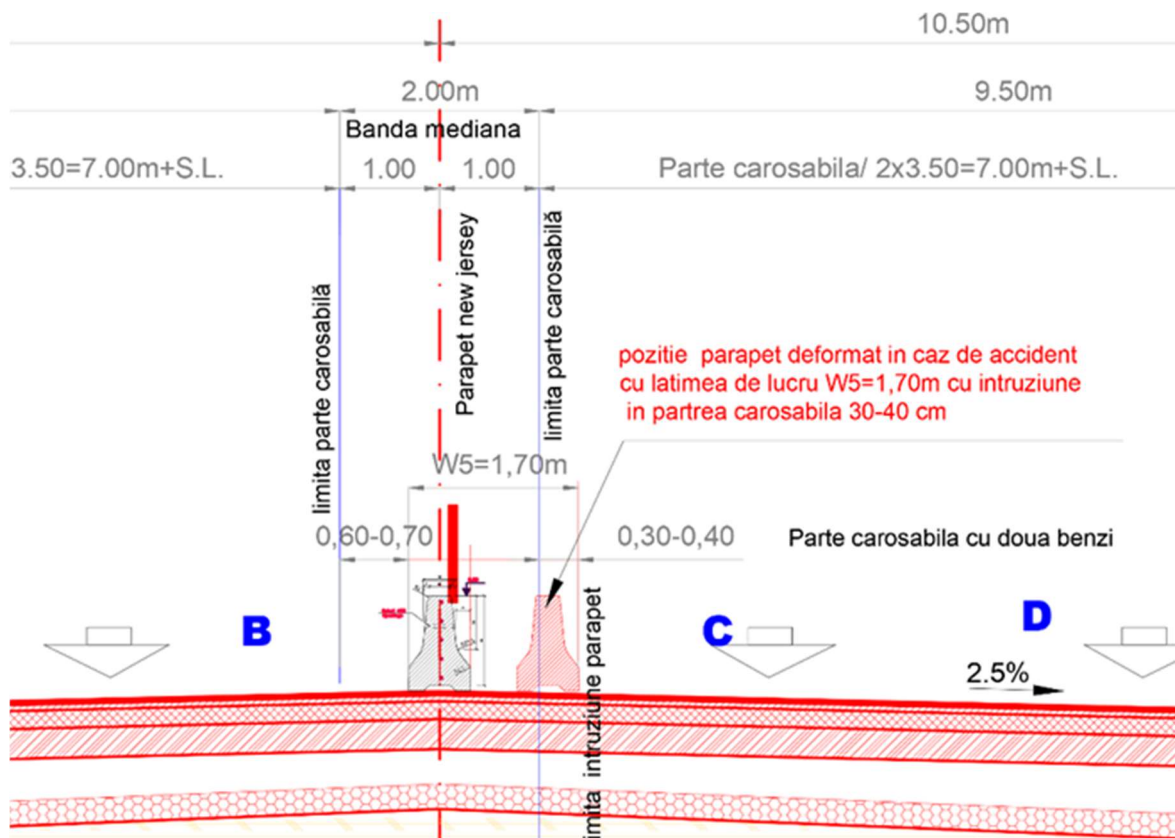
Detaliu intruziune parapet în partea carosabilă
